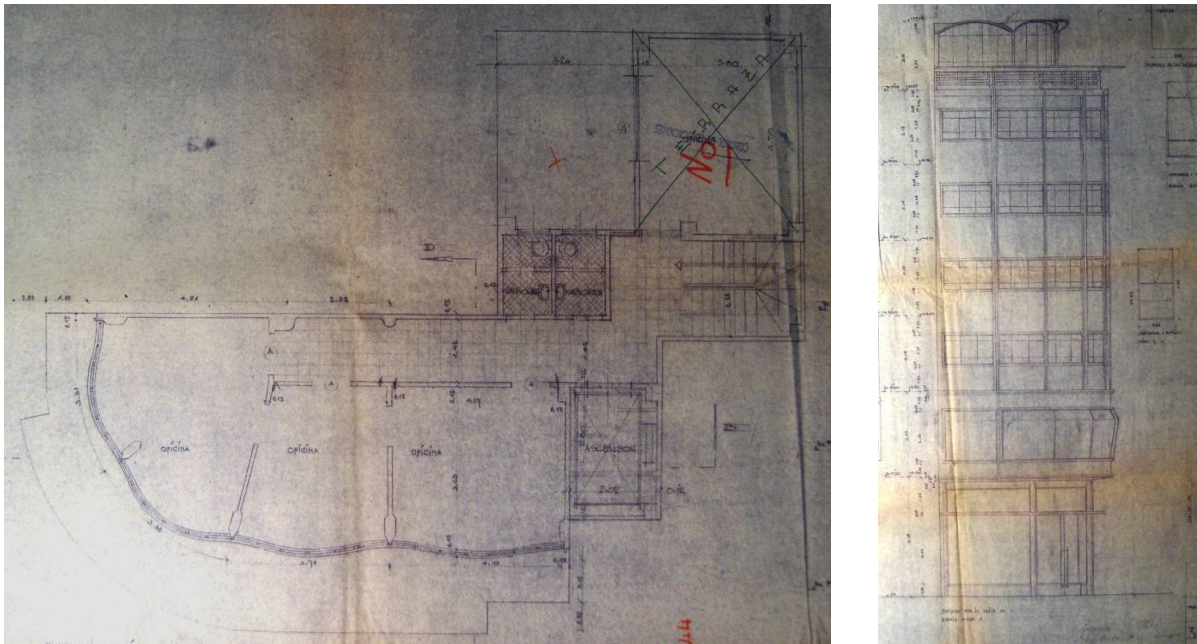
Grundriss des 7. Geschosses und Ansicht des Gebäudes.
